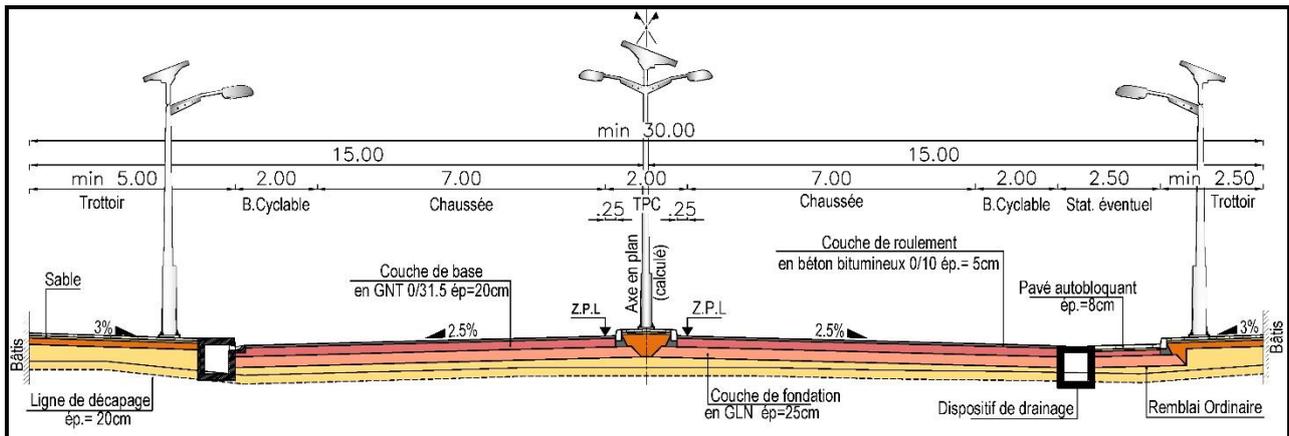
Profil en travers type de la voie n°1 d'accès aux sites touristiques de Ouidah
